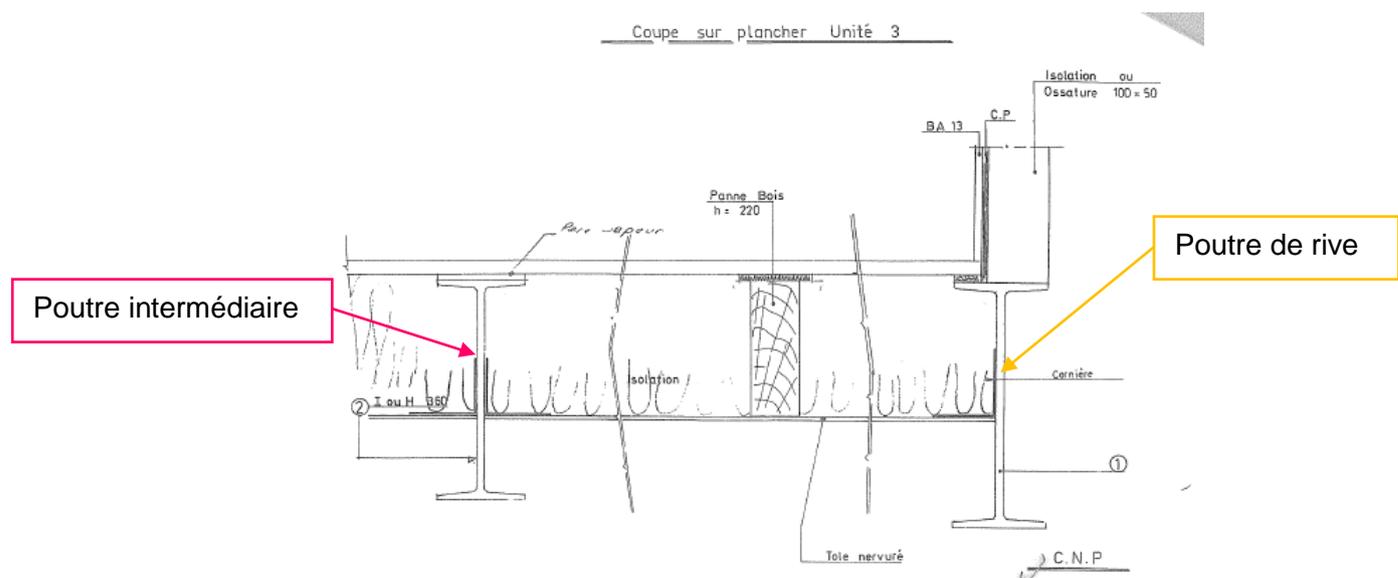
Coupe du plancher de l'unité 3 fourni par le MO
